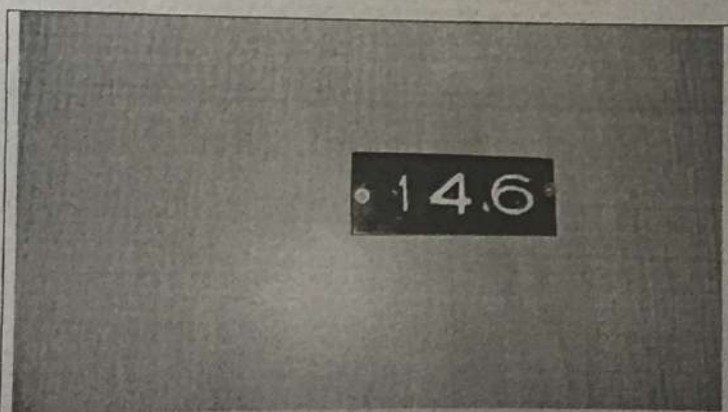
Detalhe da porta do Apartamento Nº 146.
